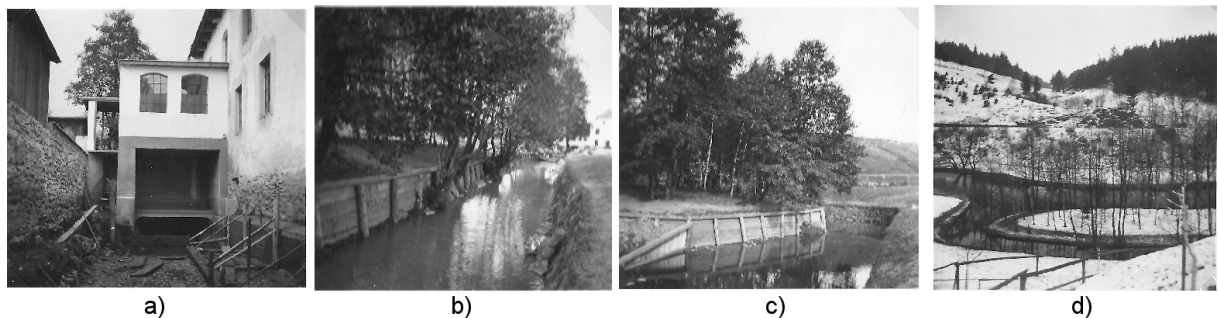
a) Stavba kašny, b) Pohled na jemné česle a jalovou propust' [16]
